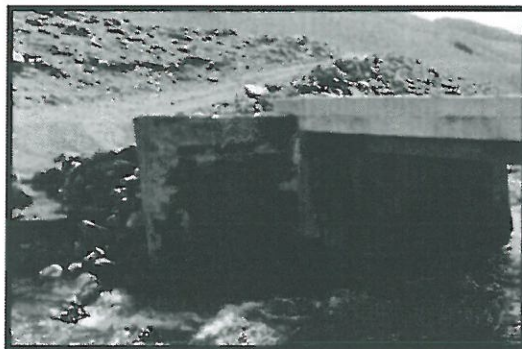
(En la presente imagen se puede observar la estructura en deterioro) El Puente se presenta en condición precaria, la subestructura del estribo del puente existente con daño severo en la base ocasionado por la socavación del río.
